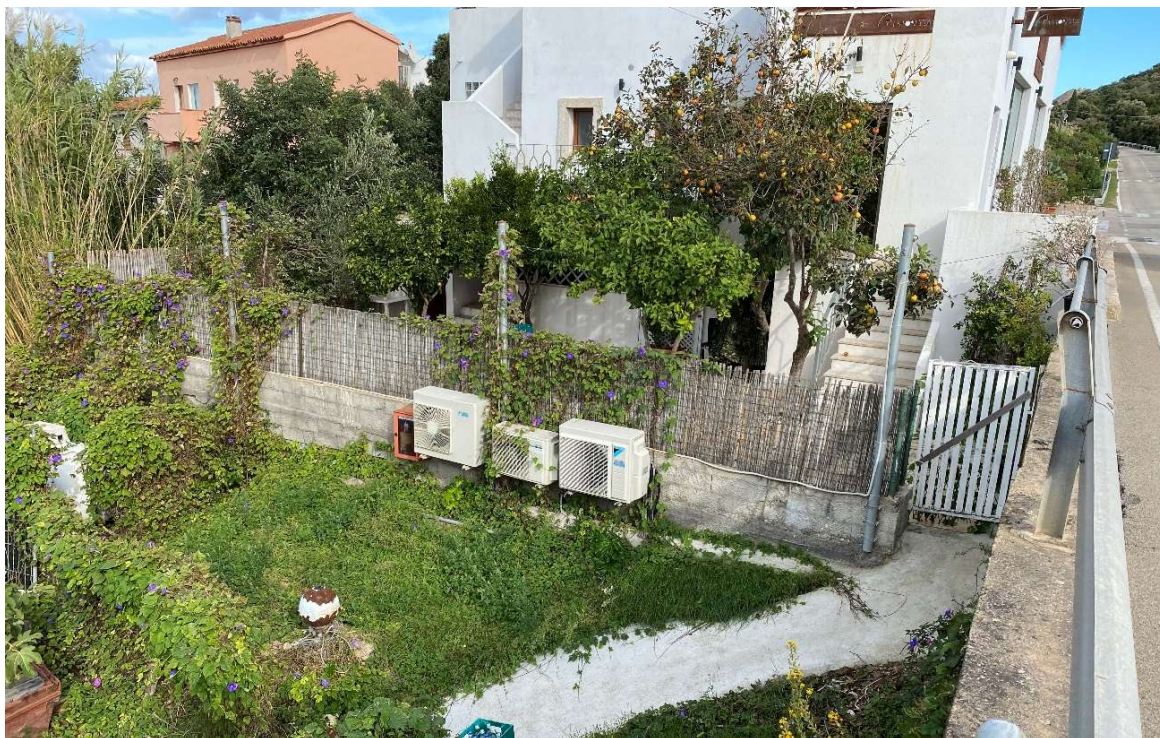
Vista del tratto n. 2 – Scala di accesso al ristorante dal compluvio e muro di recinzione (oggetto di demolizione e ripristino)
